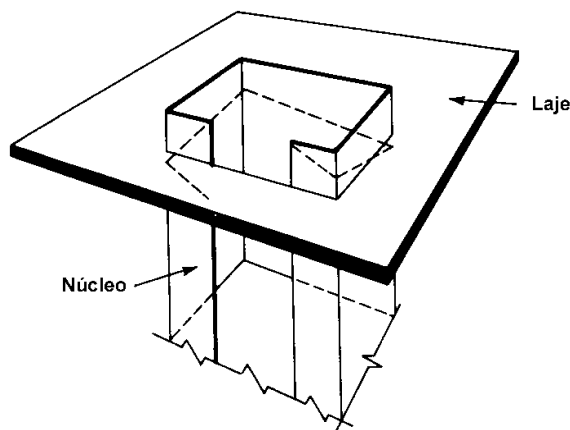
Núcleo estrutural e laje – TARANATH (1968)
